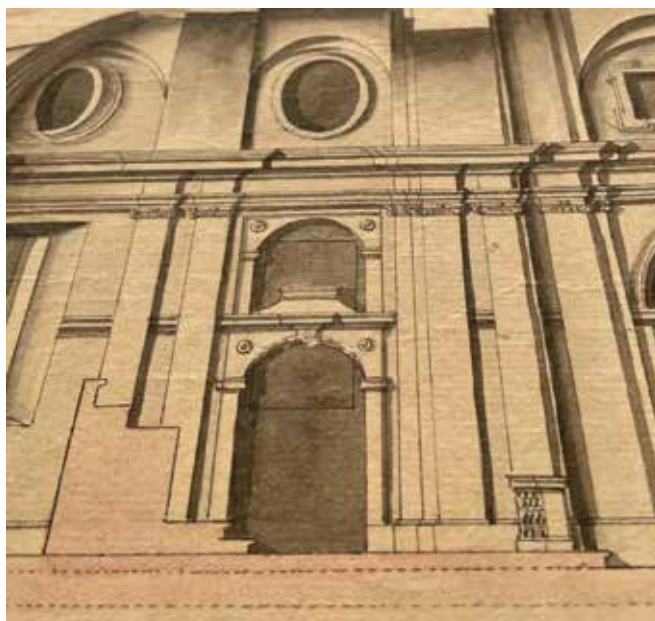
Dettaglio sezione longitudinale della chiesa con sezione dell'altare e sua balaustra in prospetto, ISCAG, Brunetta, Cartella LIX A, nr. 3706.
